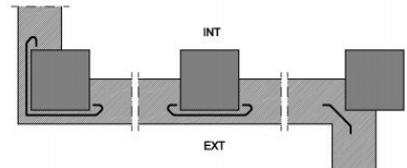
Ejemplo de encuentro de la fachada con los pilares
